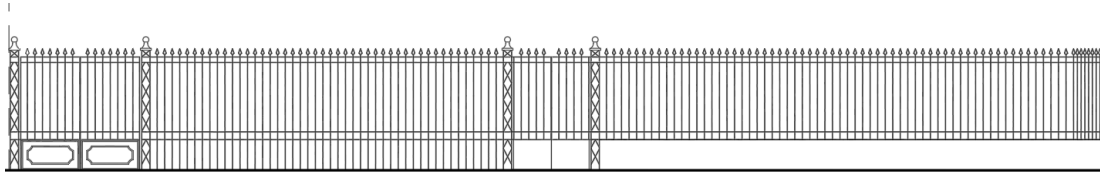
Elevación cierro Triana 843. Fuente: Elaboración propia.
